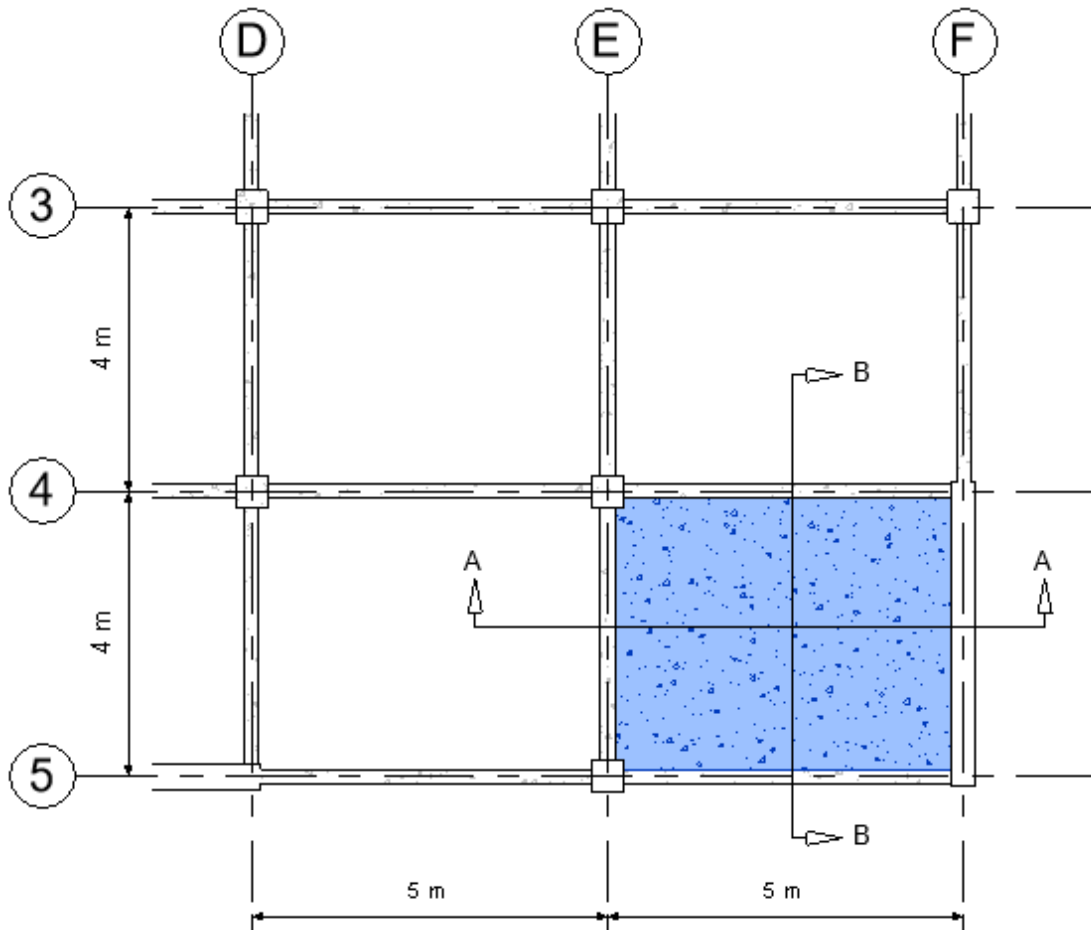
Tablero de losa de diseño. Fuente: elaboración propia.
